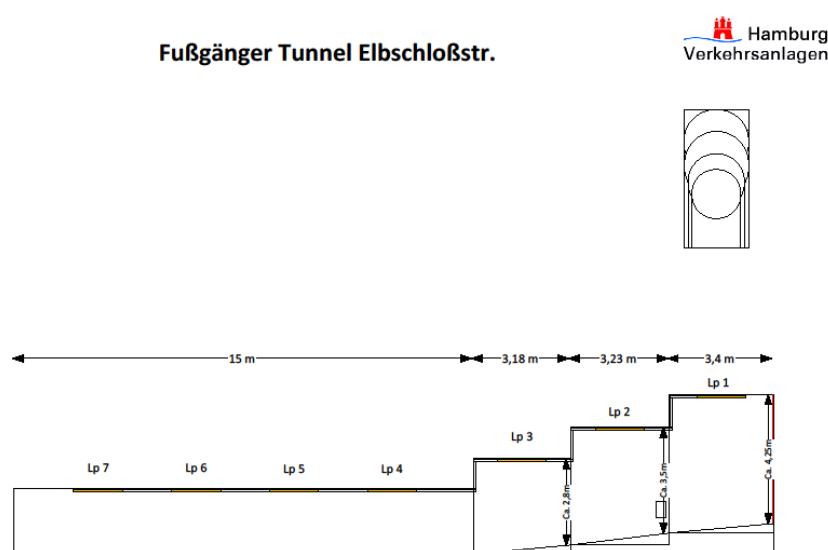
Schnitt Schröders Elbschlösstunnel, Hamburger Verkehrsanlagen
